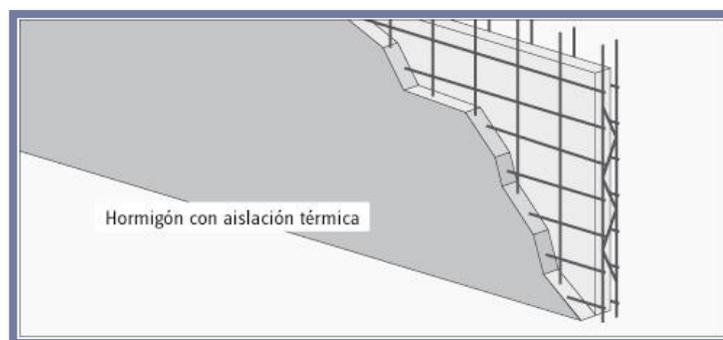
Cerramiento de Hormigón Armado con Aislación Térmica.
